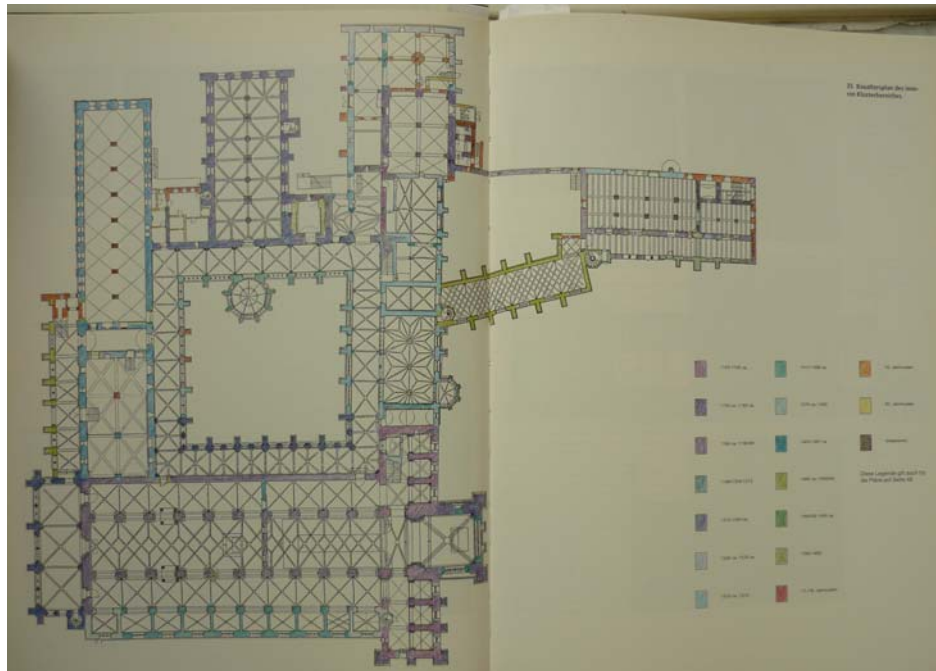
Grundriss des Kloster Maulbronn
